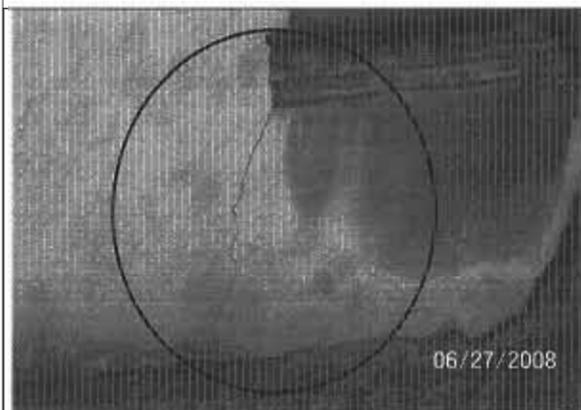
Agrietamiento en zona superior del muro de lindero
